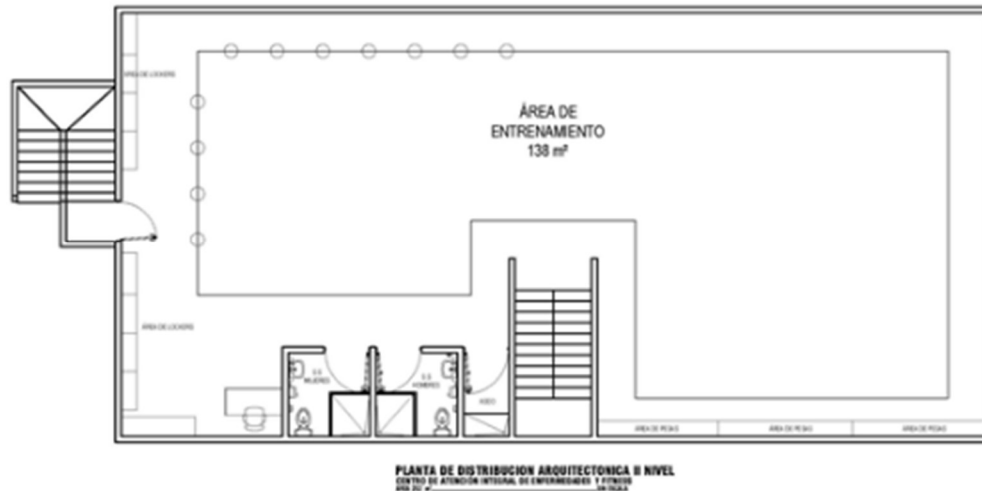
Planta de distribución arquitectónica del II nivel del edificio a remodelar.
